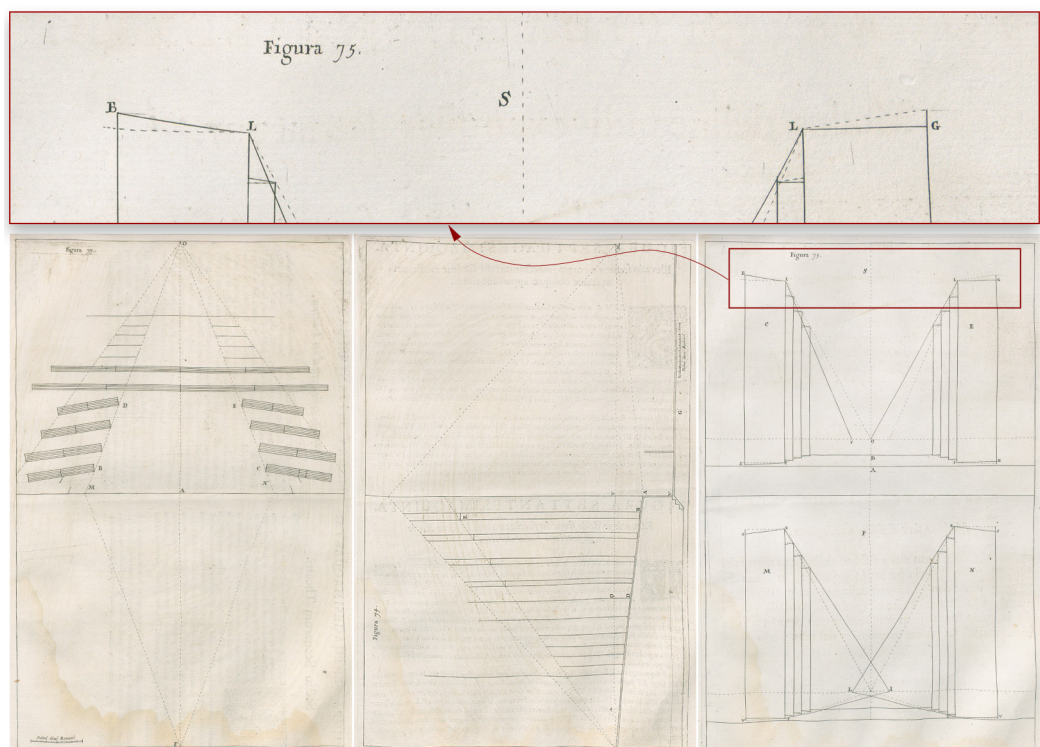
Figure 73 (pianta), 74 (sezione) e 75 (prospettiva della scena in alto e prospetto in basso) del primo libro dell'edizione del 1693 [Pozzo 1693].
